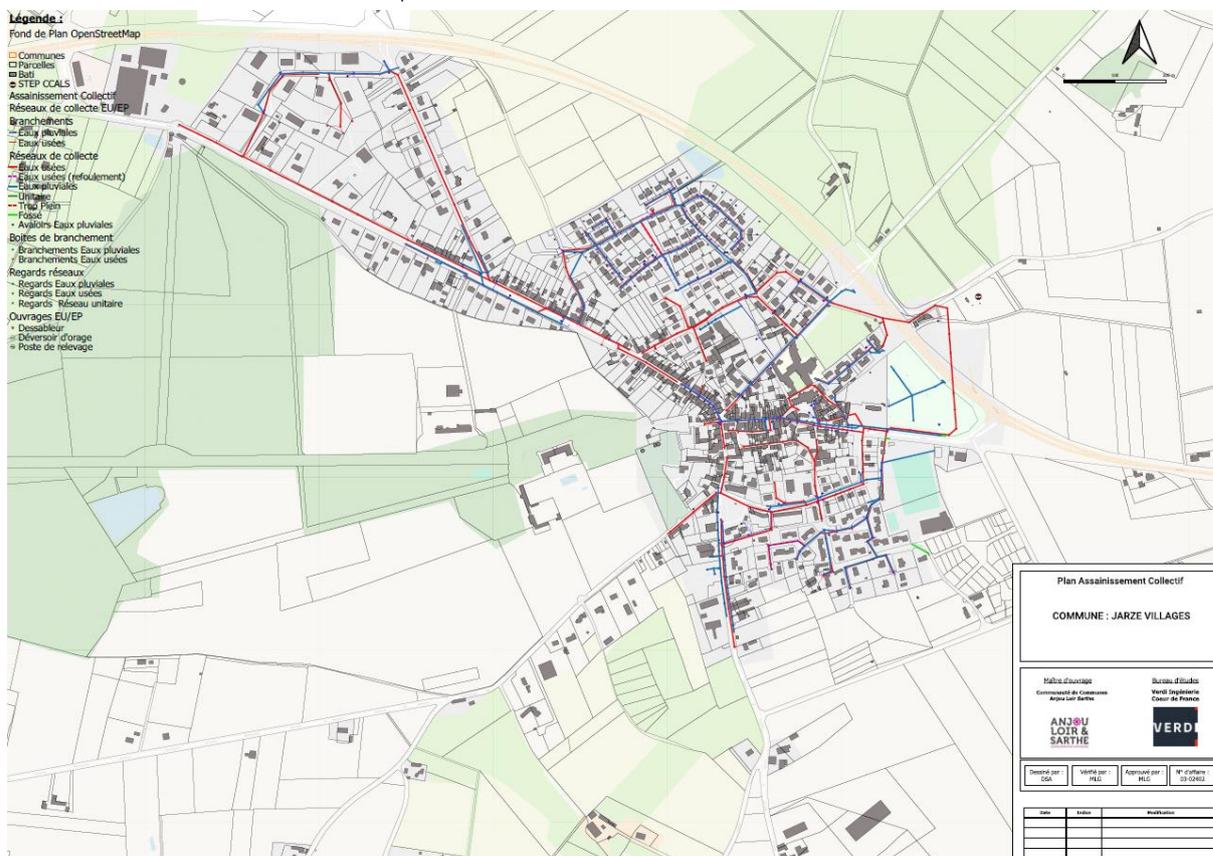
Plan de fonctionnement du réseau d'assainissement du secteur bourg
